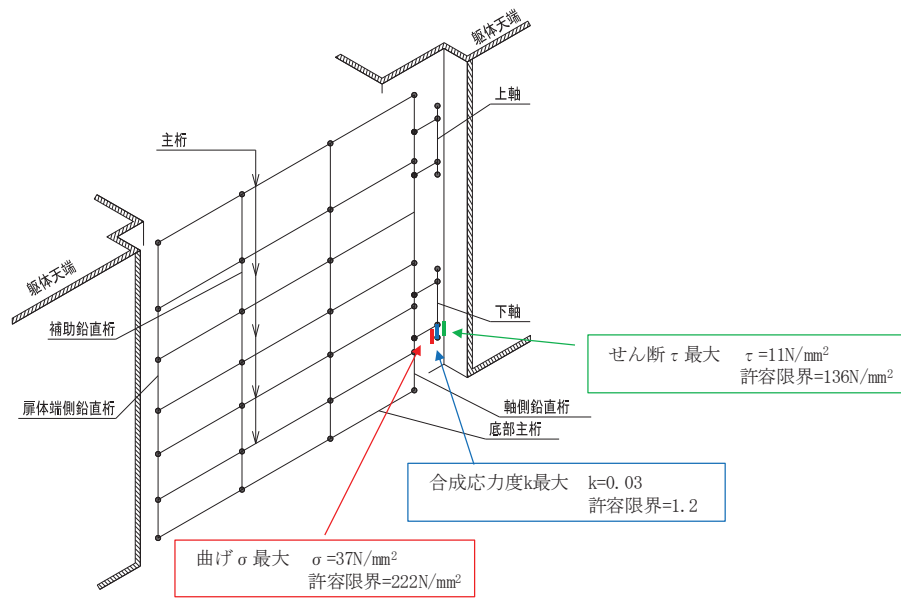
(3) ヒンジの曲げ・軸力系の破壊およびせん断破壊に対する
